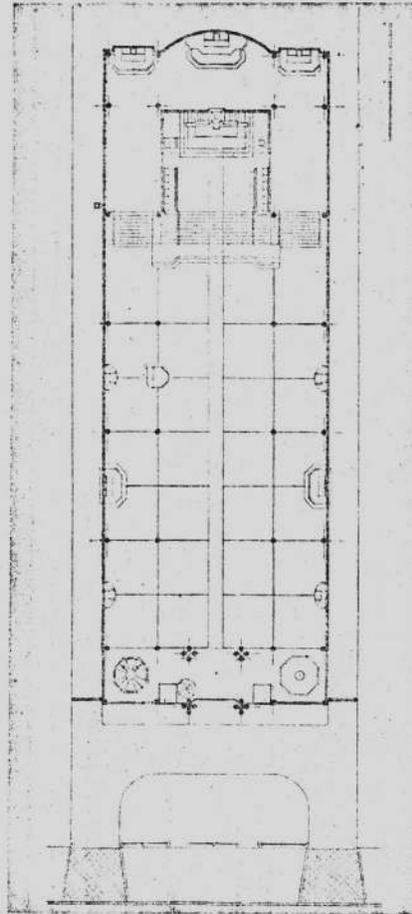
Le Raincy bei Paris. Kirche Notre Dame. Brüder Perret. 1922—23. Grundriß.
